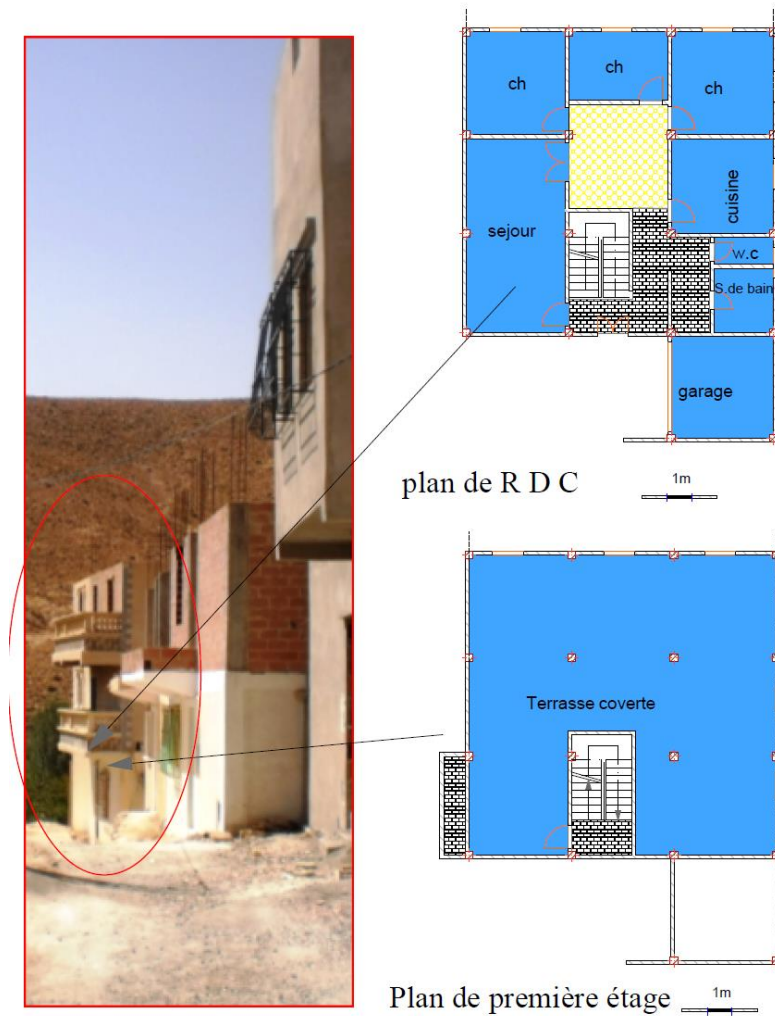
Vue extérieure et plan d'une construction dans le nouveau tissu de Menâa (Source : Auteur, 2018)
